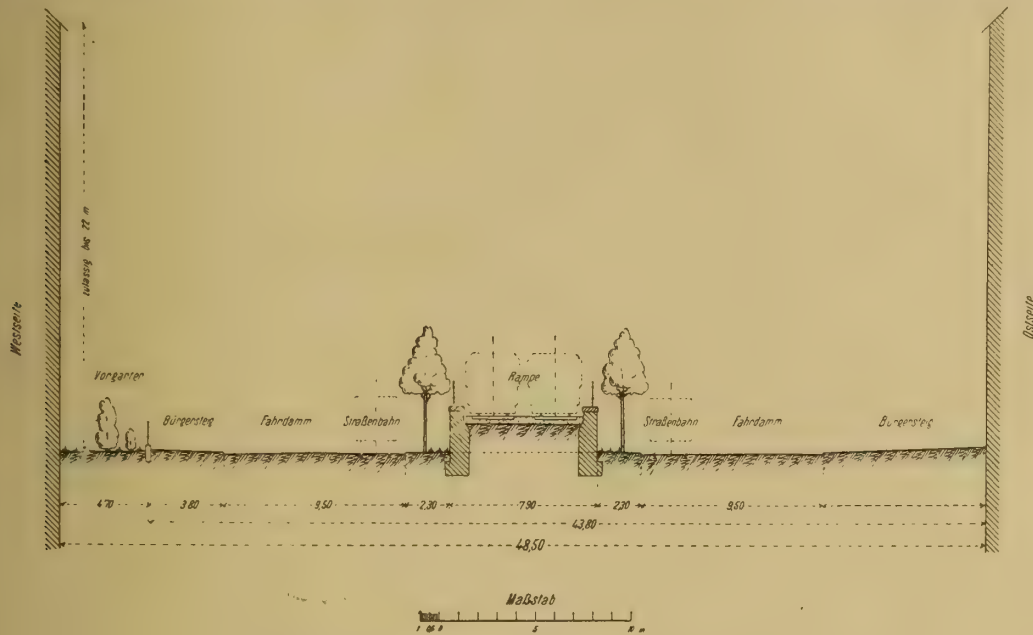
Schönhauser Allee mit Auftragsrampe.
